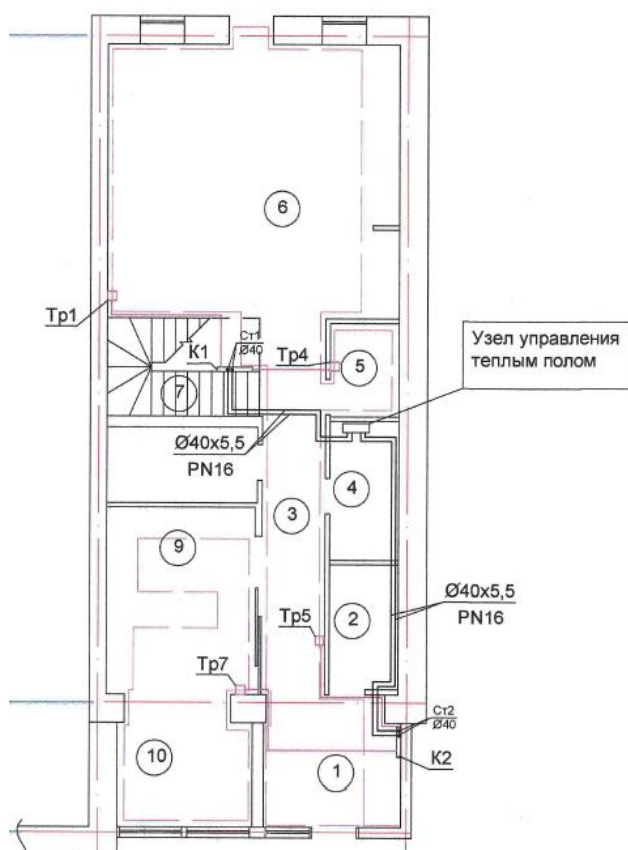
схема размещения труб и узла управления теплого пола на первом этаже дома.
